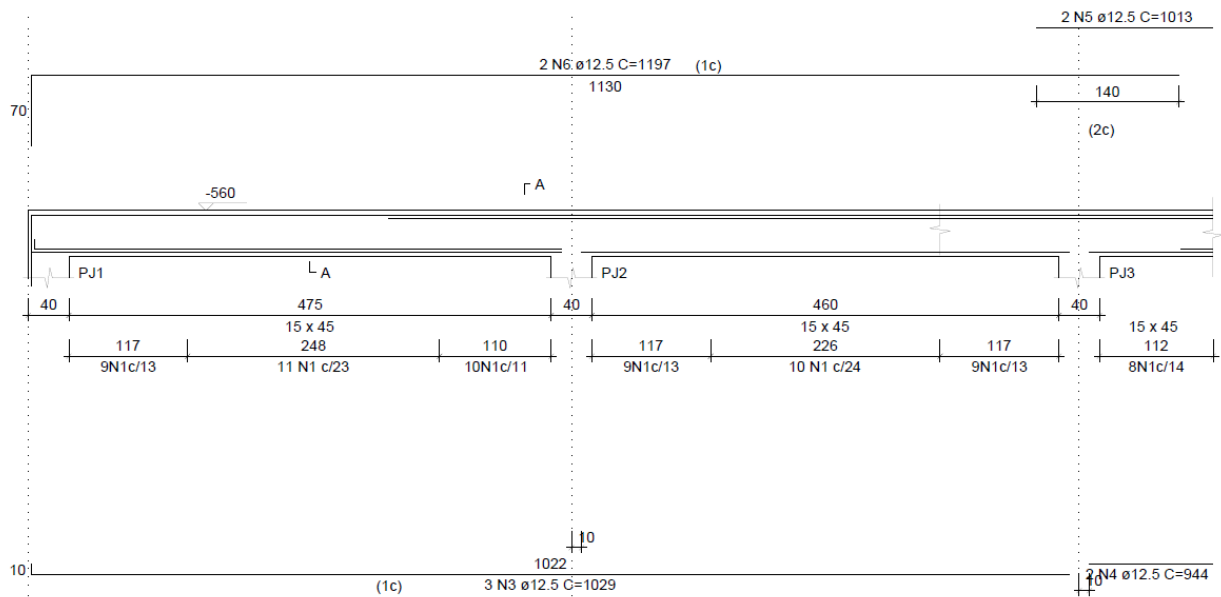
Detalhe de reforço das vigas da garagem (Seção A)
